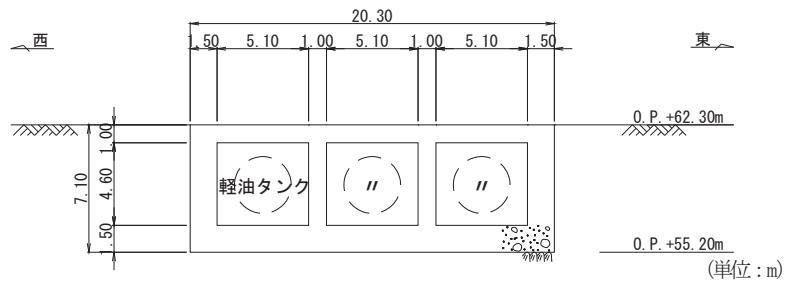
ガスタービン発電設備軽油タンク室断面図 (B-B)
